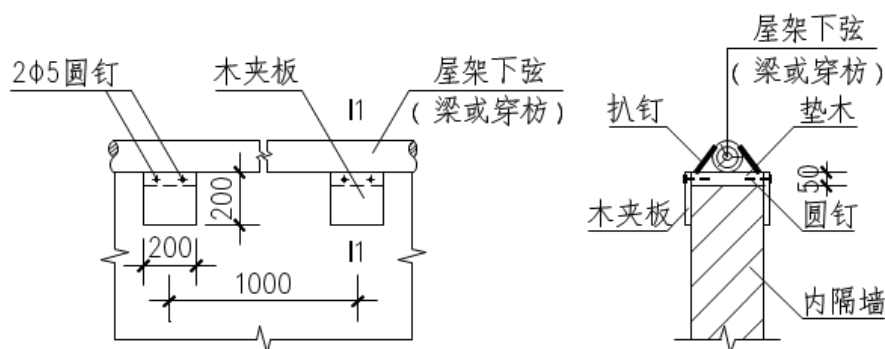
内隔墙墙顶与屋架下弦的连接（单位：mm）
